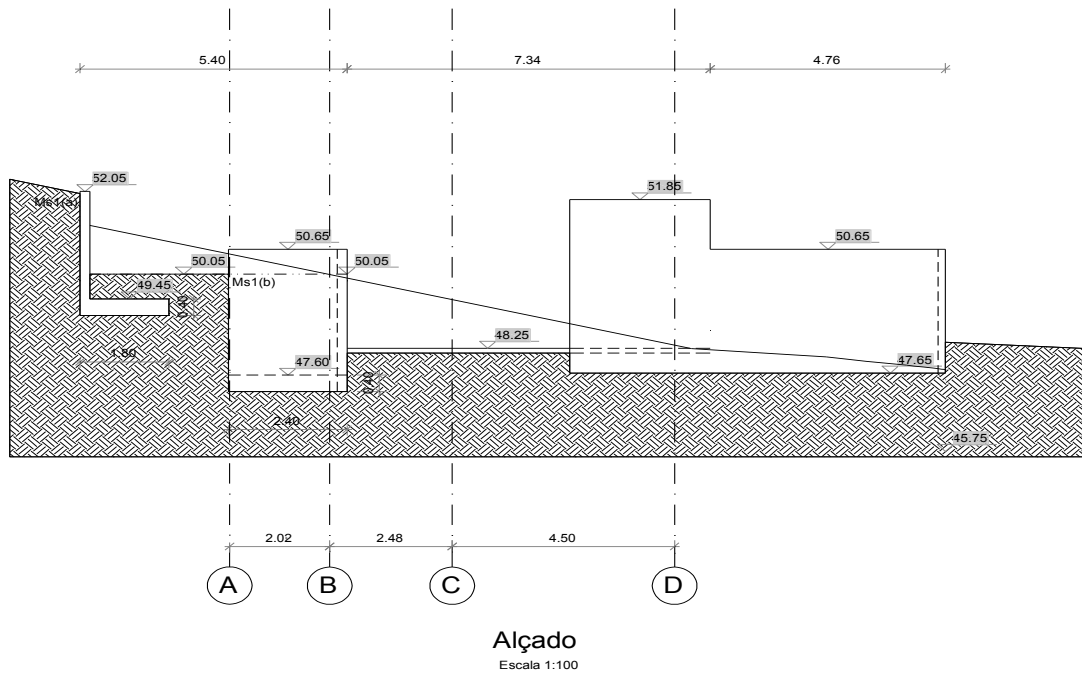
ALÇADO LATERAL DOS MUROS DE SUPORTE (AUTOCAD)
